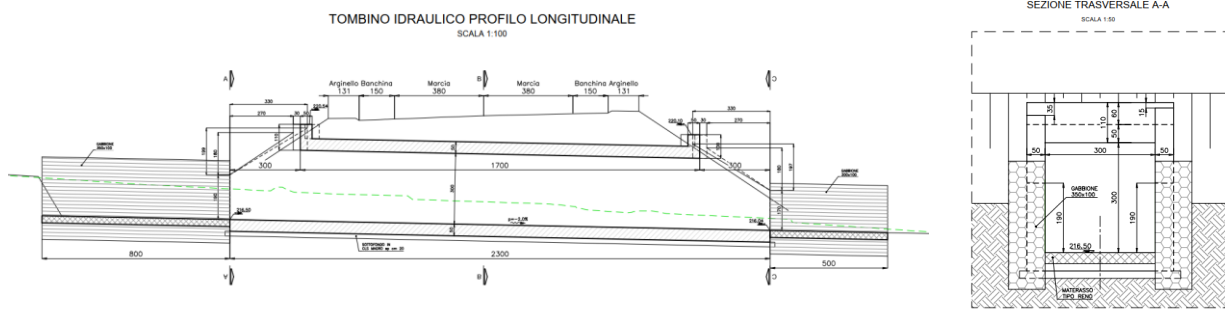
Tombino scatolare (sezione longitudinale e prospetto imbocco)
